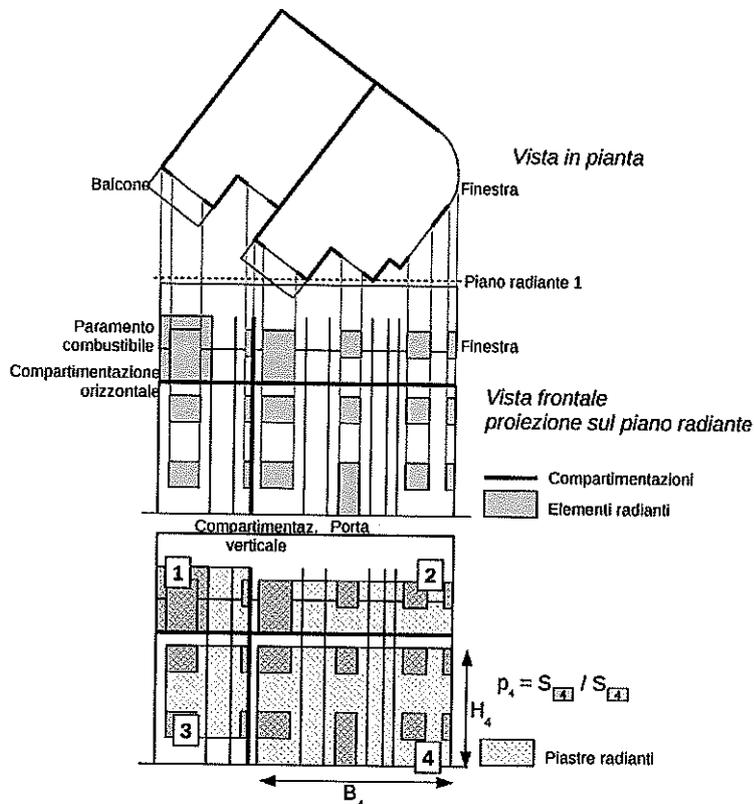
Determinazione delle piastre radianti, vista in pianta e frontale
